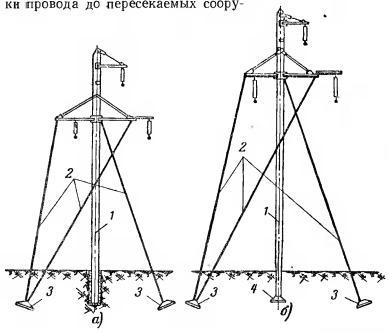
Угловая железобетонная опора на оттяжках. а — установленная в пробуренный котлован; б — установленная на подножник; 1 — опора; 2 — оттяжка; 3 — анкерчые плиты; 4 — подножник.
